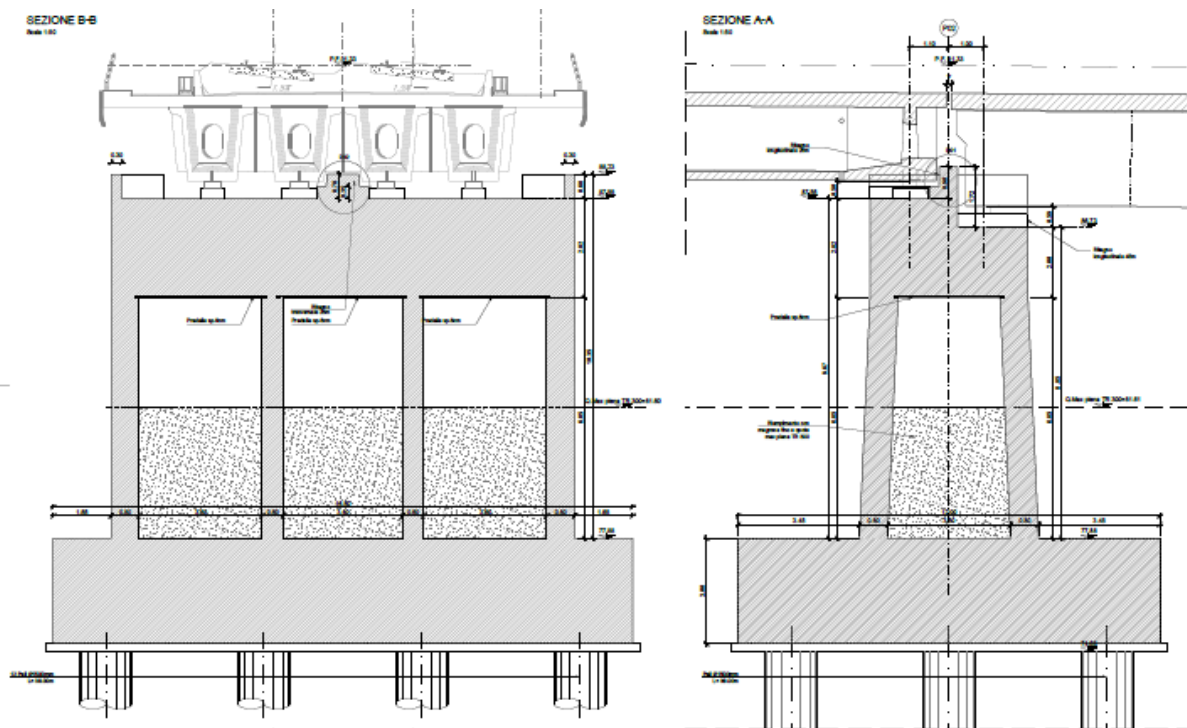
Sezione in direzione trasversale e longitudinale rispetto all'asse del viadotto pile P2
